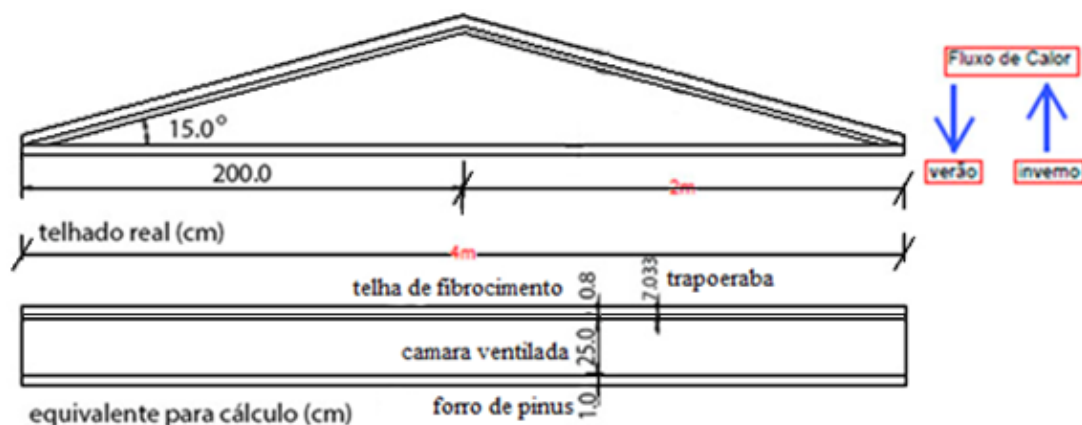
Representação simplificada do telhado inclinado com telha de fibrocimento e trapoeraba, forro de pinus e câmara de ar ventilada, adaptado da ABNT NBR 15220:2003 [1]
